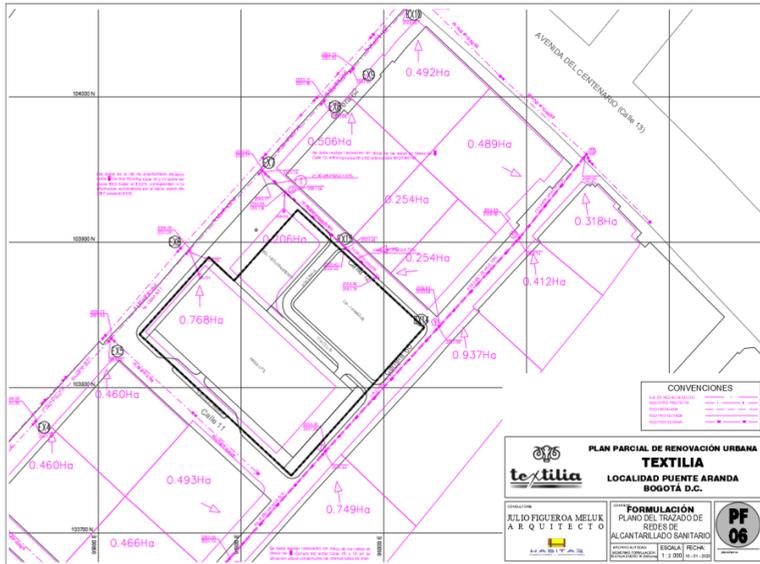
Plano PF-06 Trazado de Redes de Alcantarillado Sanitario
